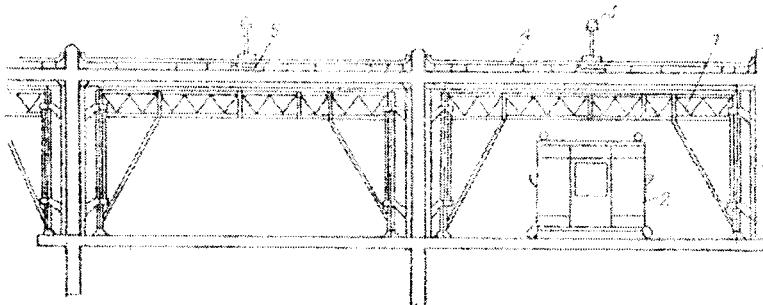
Схема подключения щитов объемно-переставной опалубки при прогреве бетона
